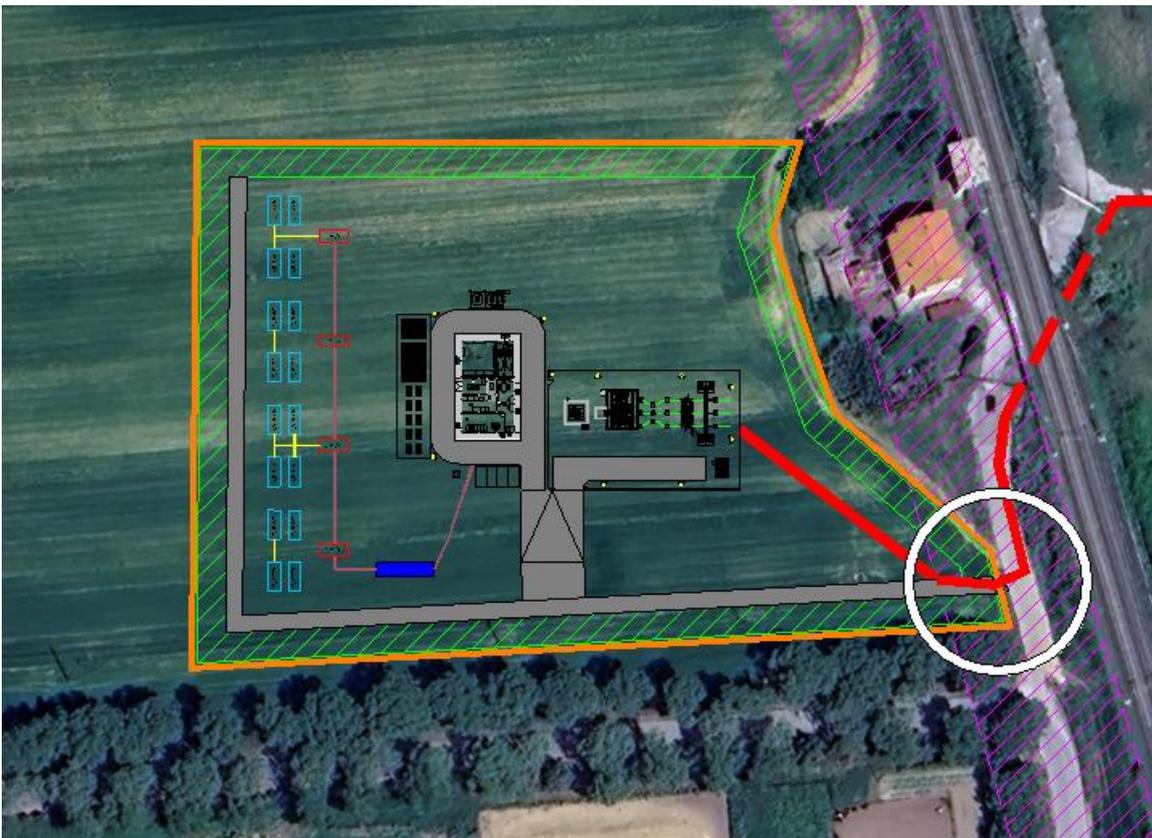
Ubicazione dell'accesso all'impianto BESS
